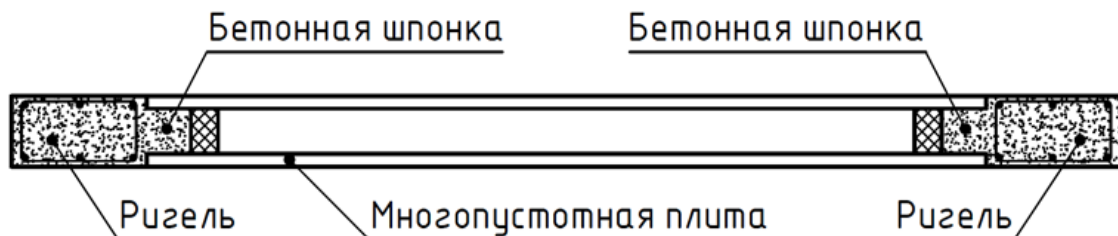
Примыкание монолитных железобетонных ригелей к многопустотной плите перекрытия
